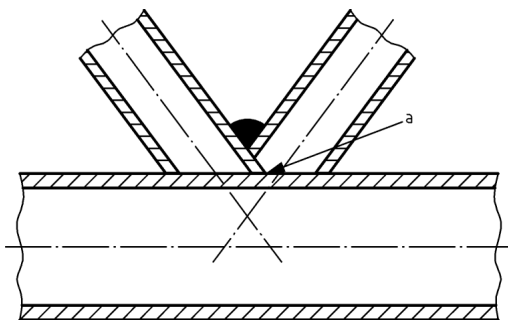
Підготовка та підгонка контурів зварного шва. Кутові зварні шви при з'єднанні квадратних і прямокутних порожнистих профілів в'язей із поясом ферми
